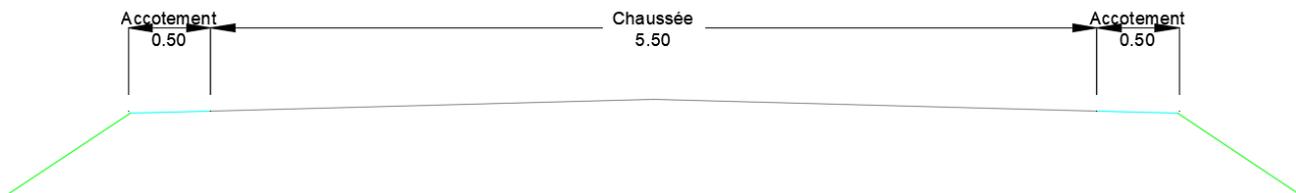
Schéma de profil en travers sur les routes à élargir.
